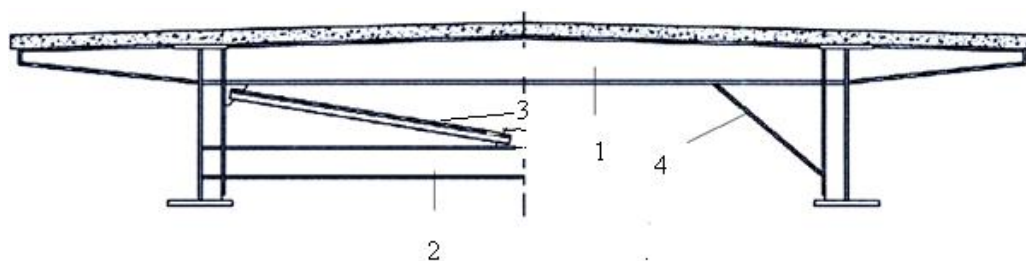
Сварное соединение поперечных связевых балок с пролетной балкой [23]
